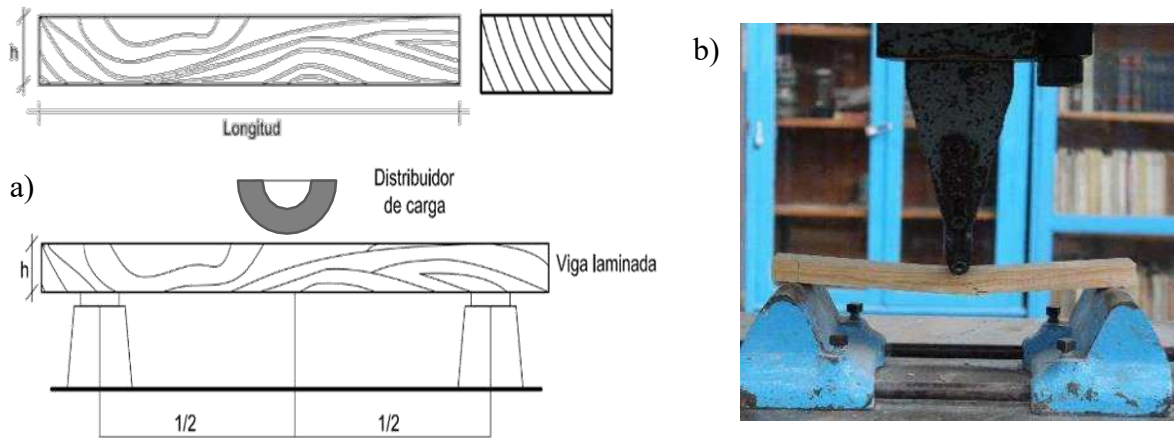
a) Esquema de prueba mecánica, b) Prueba mecánica, fractura ensayo a flexión
